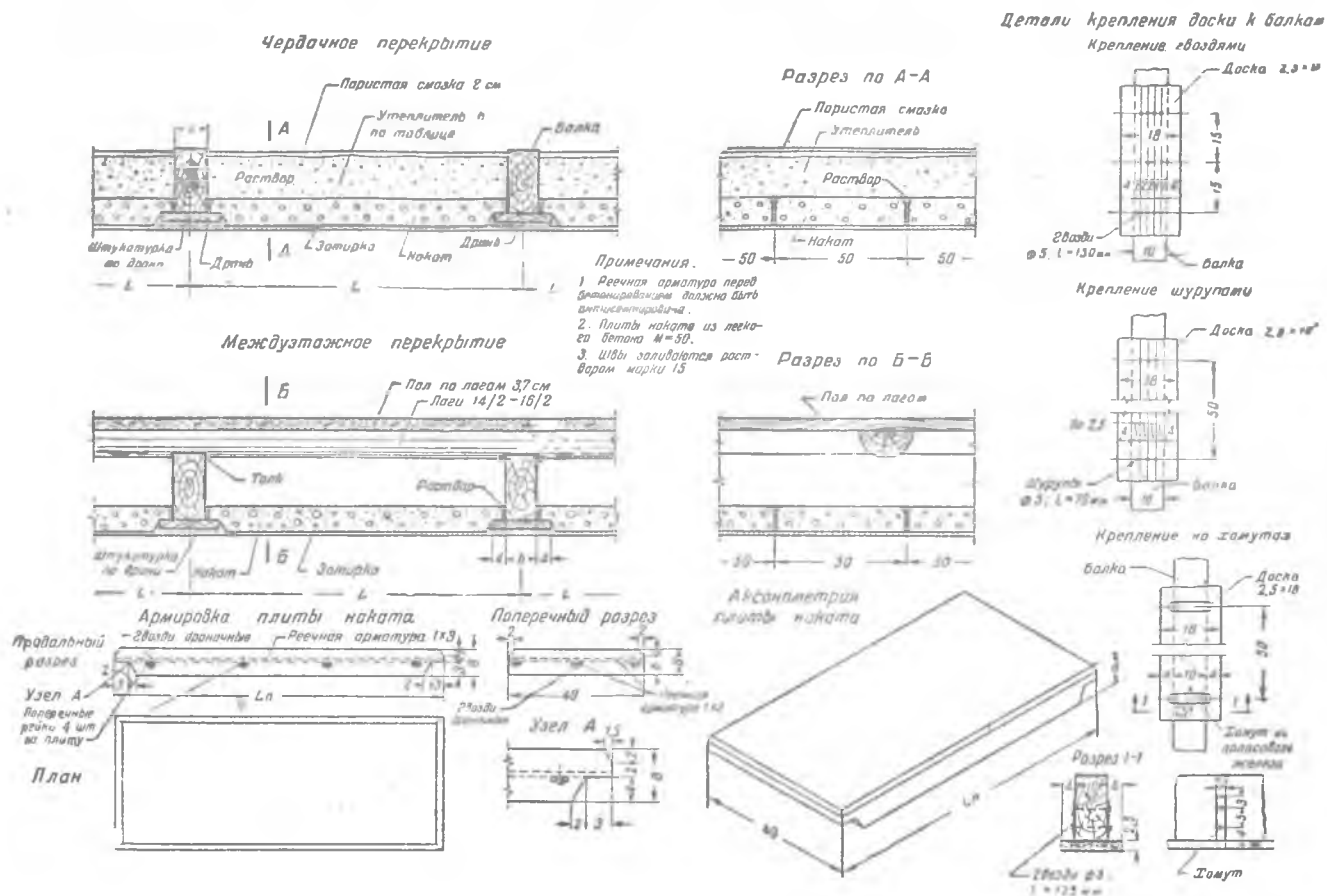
Перекрытия с несущим накатом и гладким потолком по деревянным балкам
